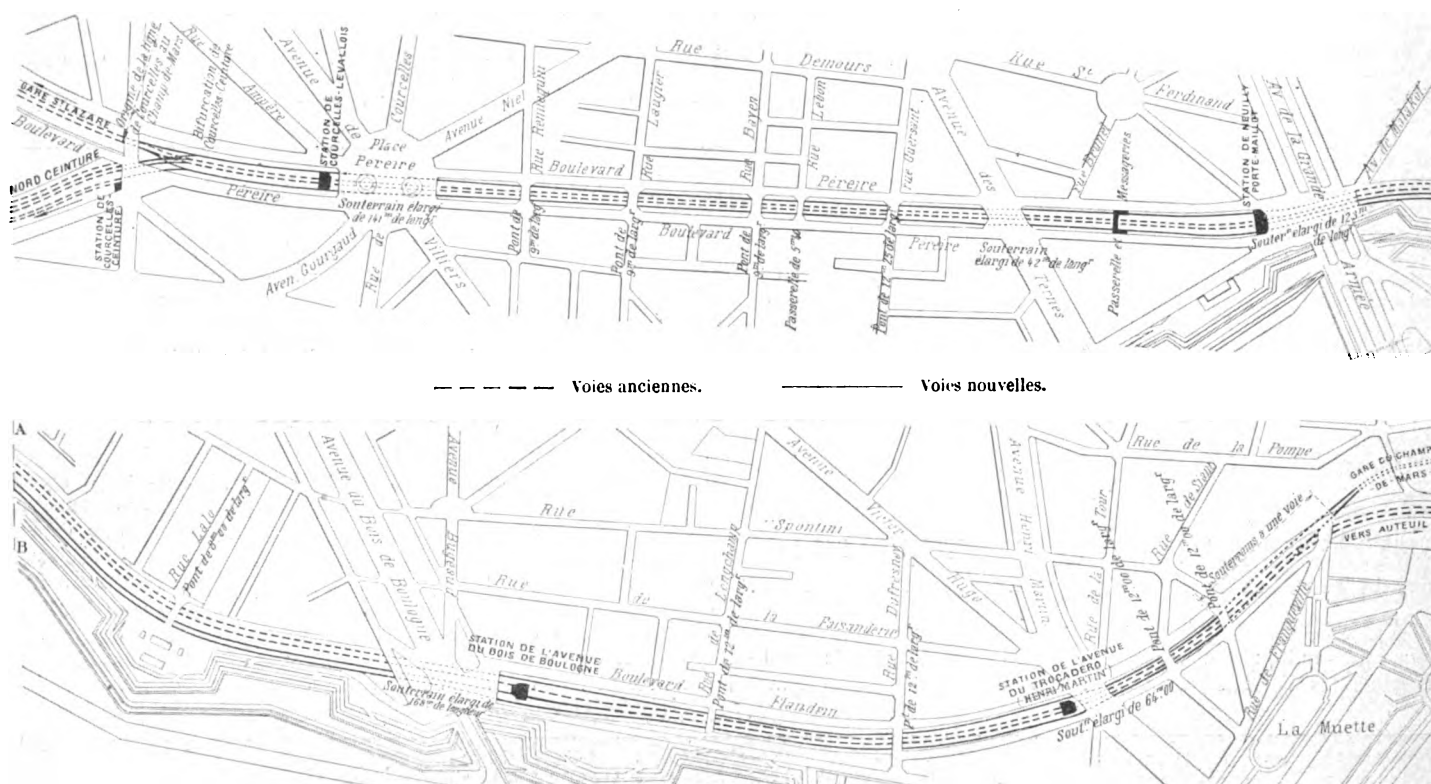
Plan général du doublement des voies entre Courcelles et Passy.
